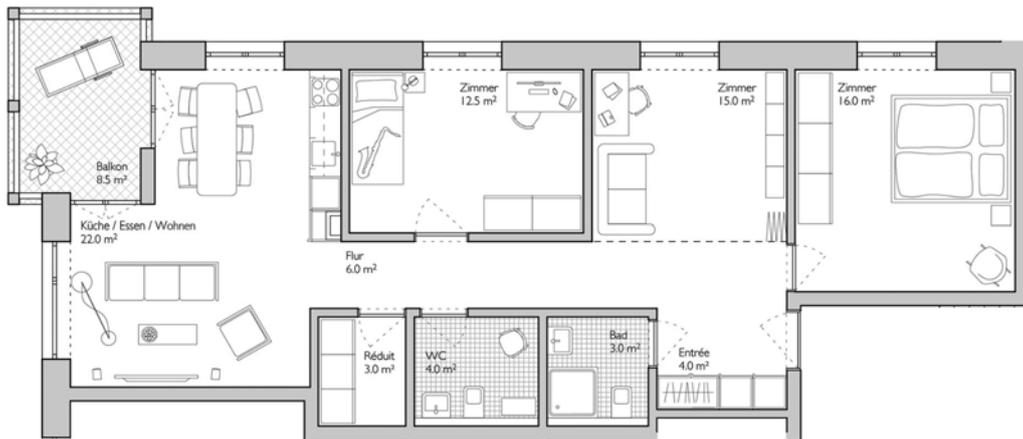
Wohnungsgrundriss 3.5 Zimmer - Whg.
